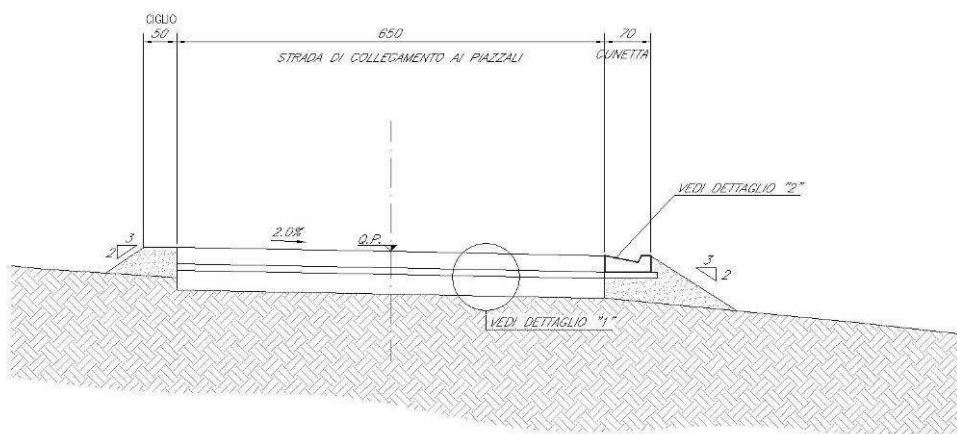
Stralcio sezione tipo viabilità di cantiere
